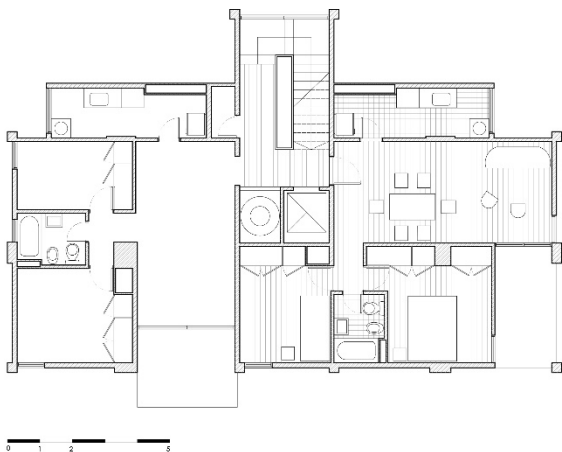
Conjunto Rioja. Planta tipo torres n° 2, 4 y 6. Elaboración del autor.
